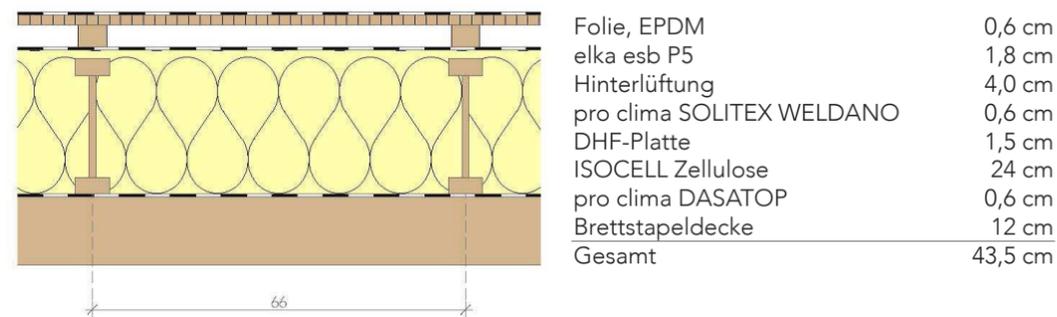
Dachaufbau, eigene Darstellung, Quelle: Capital [A] architects, Stand 14.10.2019
